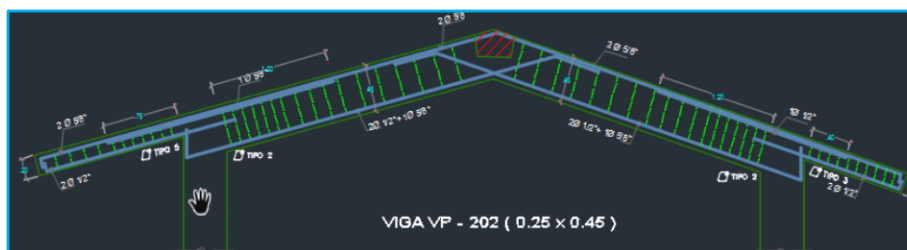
Detalle de las dimensiones de la viga VP-202 y el acero de refuerzo
